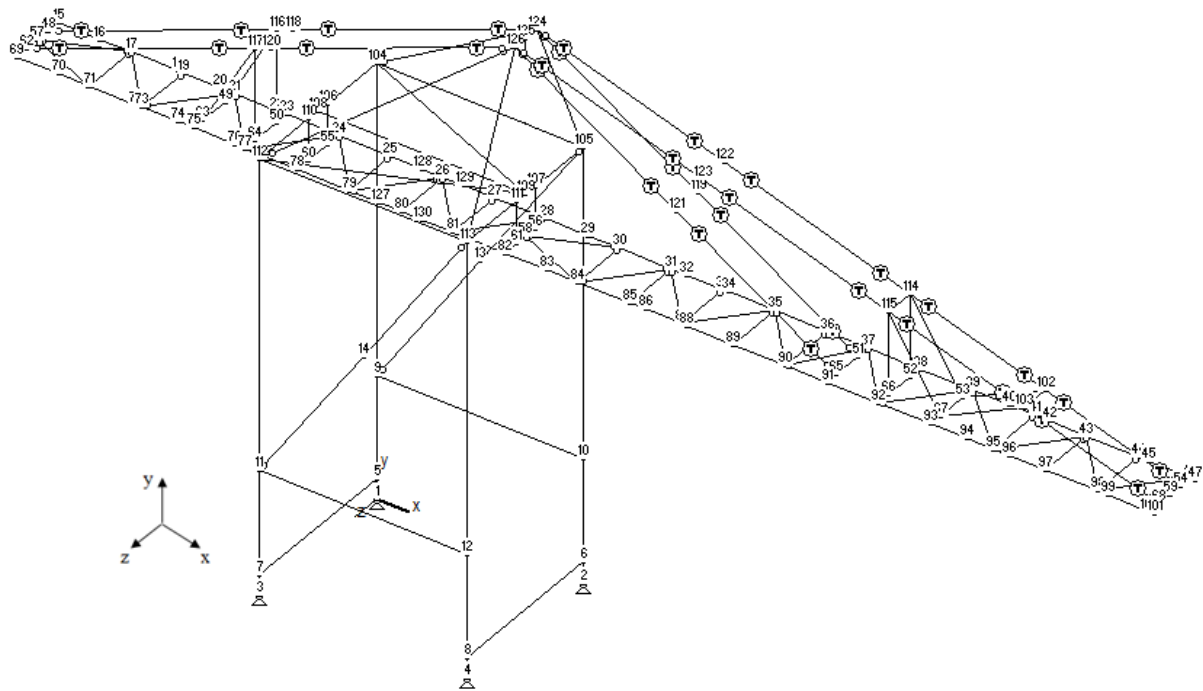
Esquema estático da estrutura (análise tridimensional)
